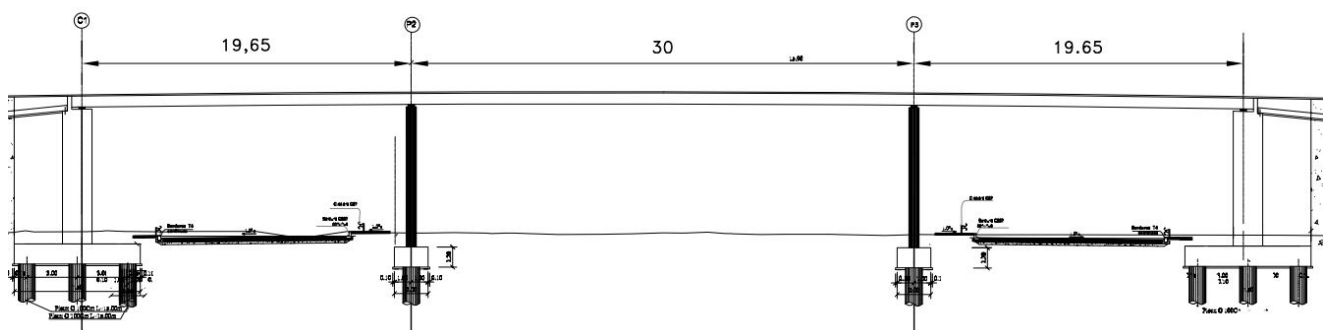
Profil en long variante 1 pont dalle en béton précontraint
